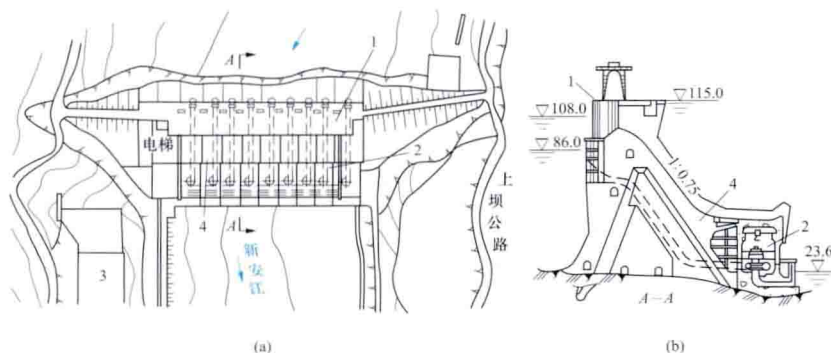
新安江水电站枢纽平面布置及溢流坝剖面图
